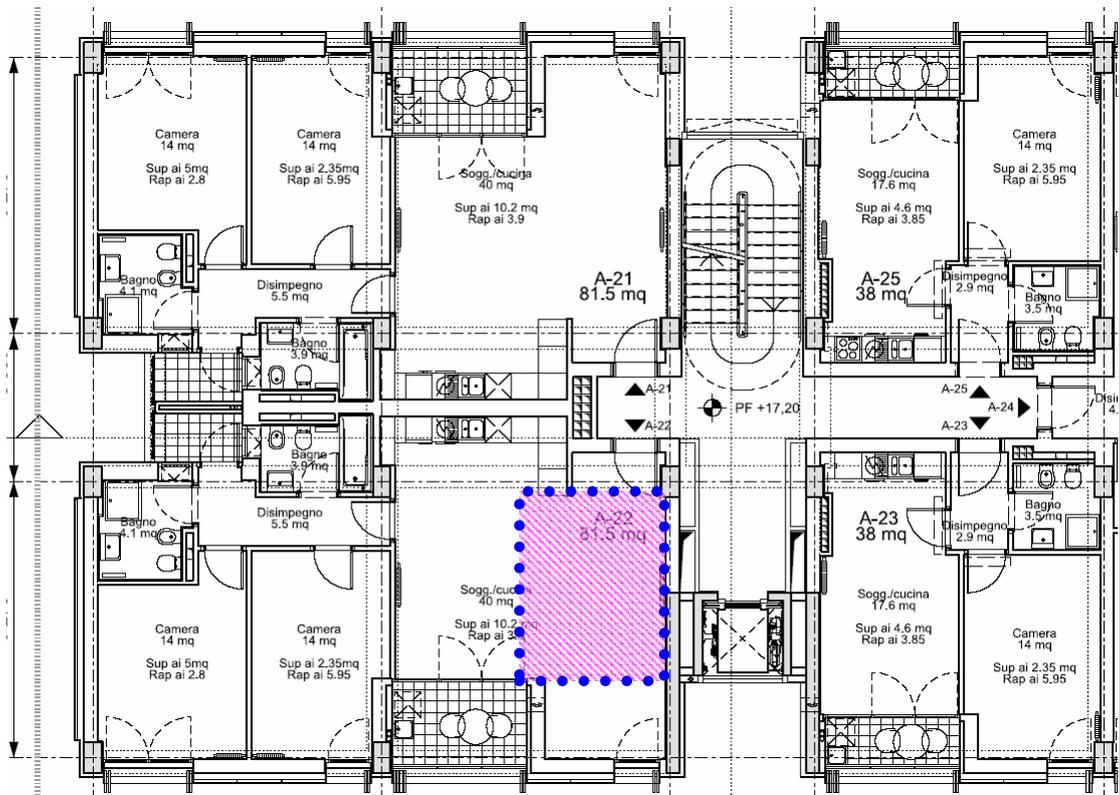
Proiezione della porzione di solaio oggetto di verifica sul piano tipo
